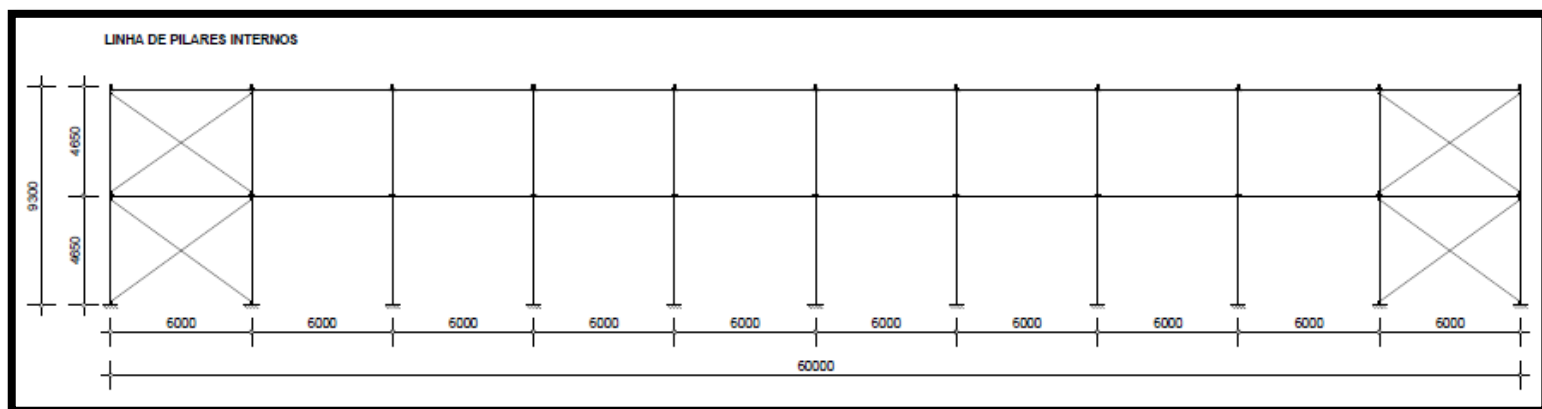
Elevação longitudinal dos pilares internos do *Compost Barn
